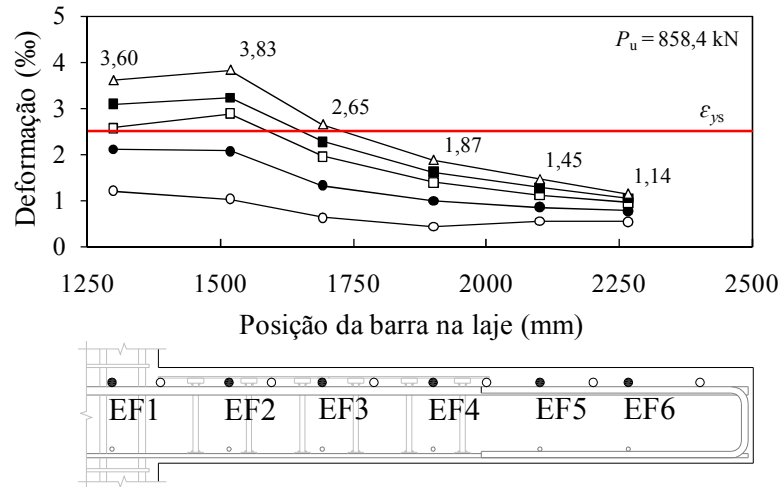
Deformações nas armaduras de flexão da laje LC01
